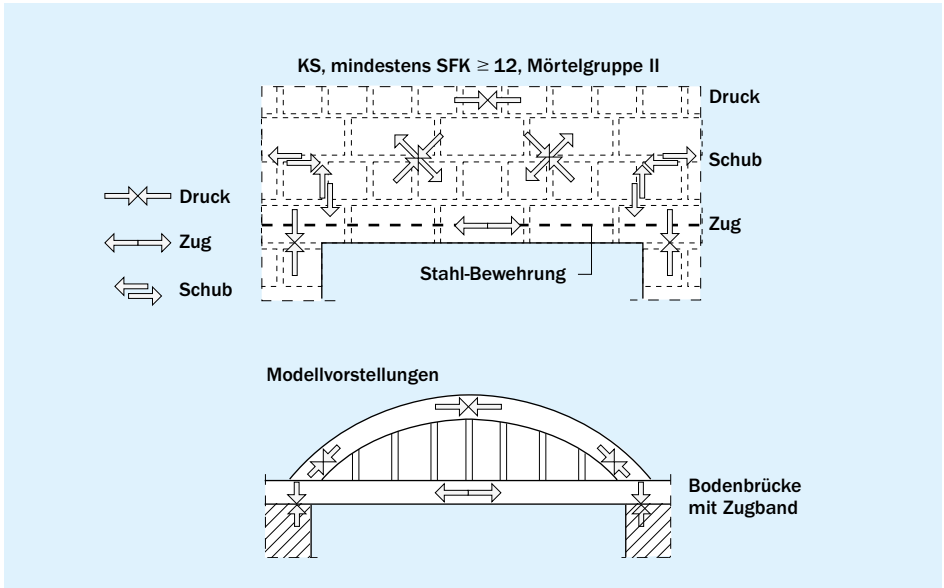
Zur Lastableitung über Öffnungen muss ein Zuggurt (unten) und ein Druckgurt (oben) ausgebildet werden.
